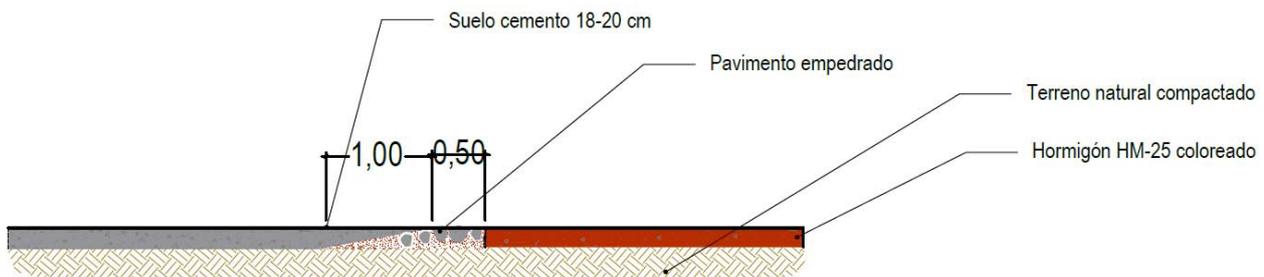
detalle sección longitudinal zonas de transición de pavimentos
